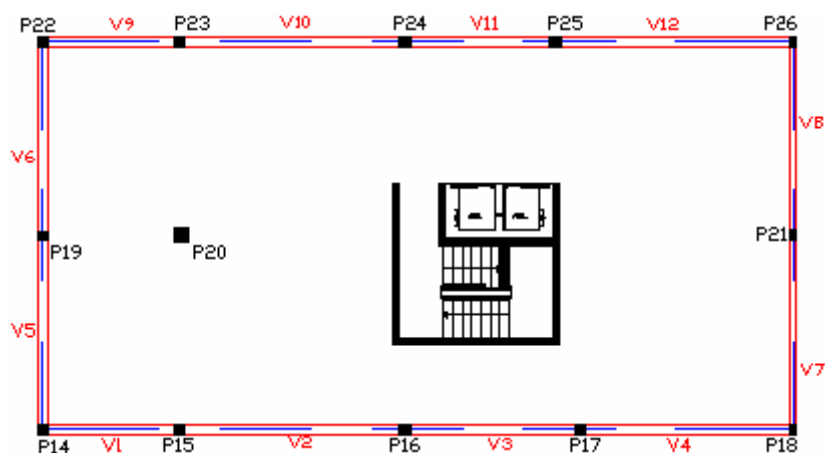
Desenho esquemático da planta estrutural da laje de cobertura
